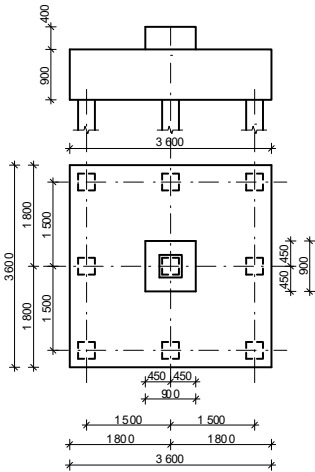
Конструктивне рішення фундаменту за варіантом 2
